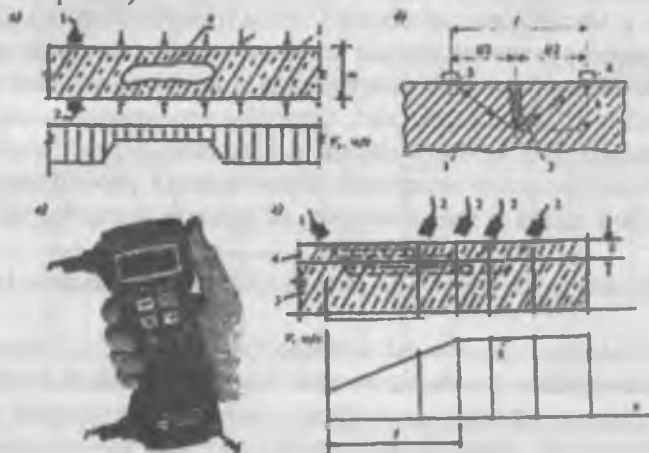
Определение дефектов железобетонной конструкции ультразвуком:
